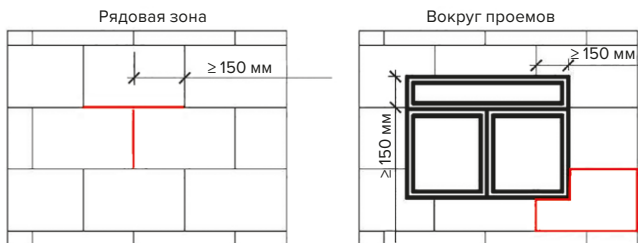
Схема установки плит на плоскости фасада и вокруг проемов
